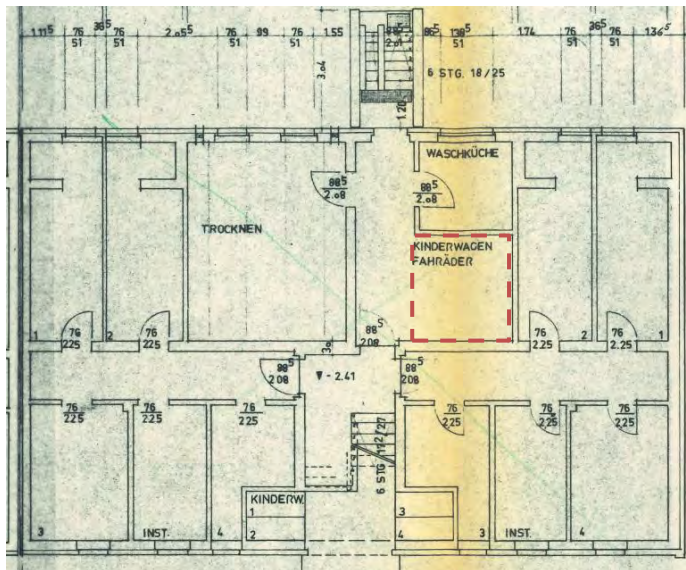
Grundriss Kellergeschoss mit möglichem Ort für Heizungsraum
